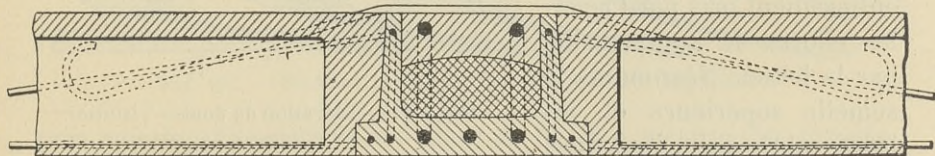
Poutre principale et poutre creuse, système Siegwart.
